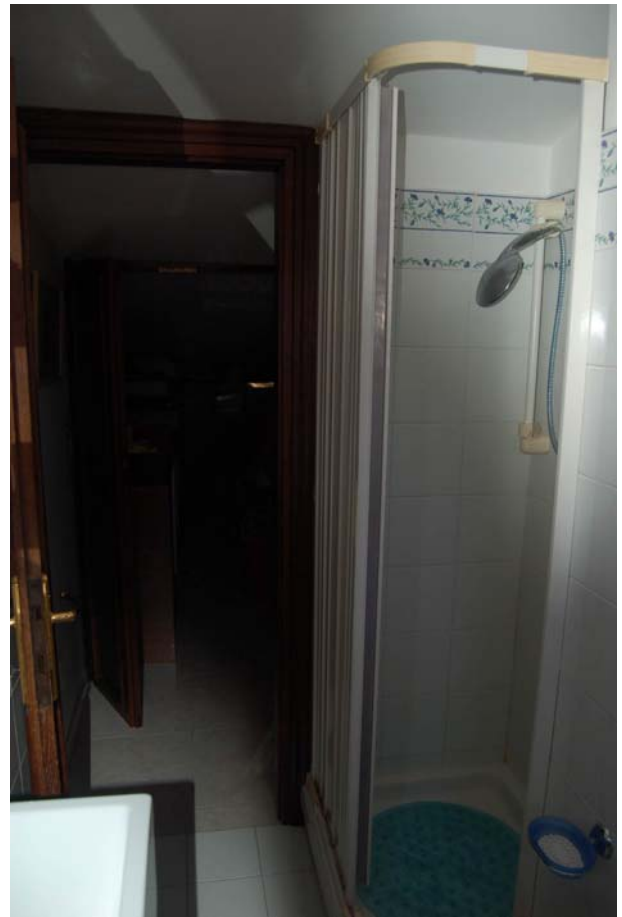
dettaglio solaio bagno privato della camera su soppalco
